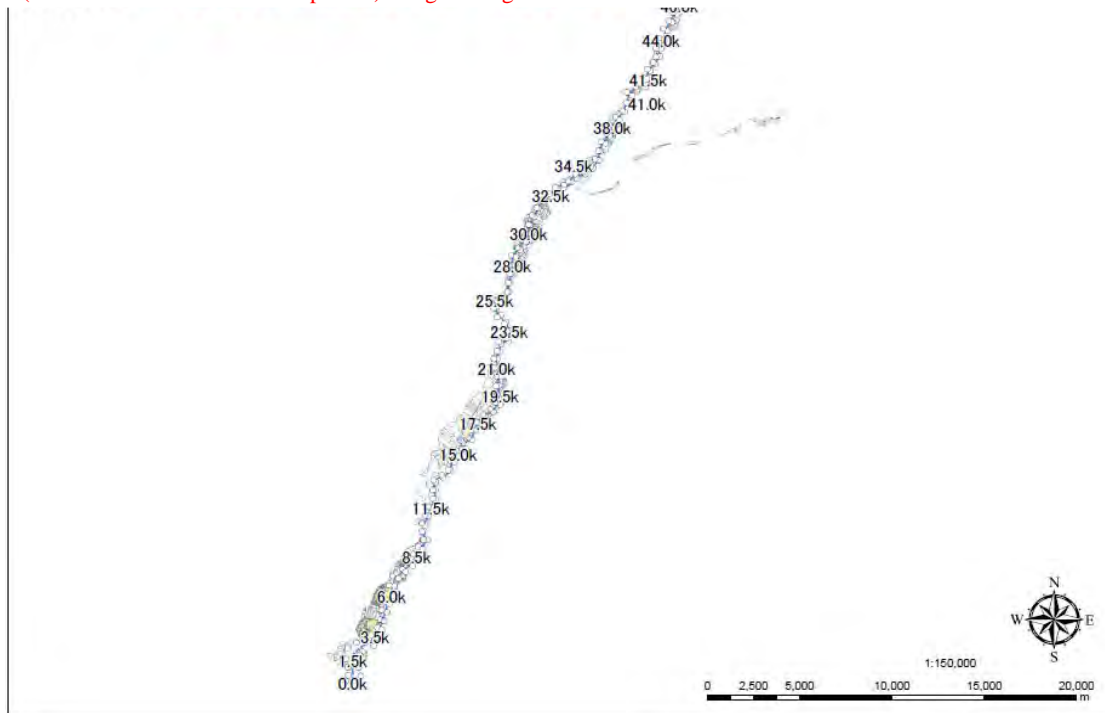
Alcance de las obras de construcción de diques en el Río Yauca
